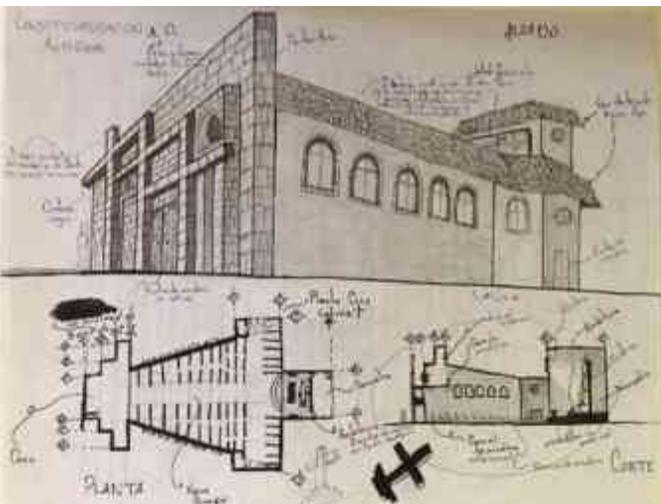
“Segunda propuesta de la capilla, corte, fachada y planta”
